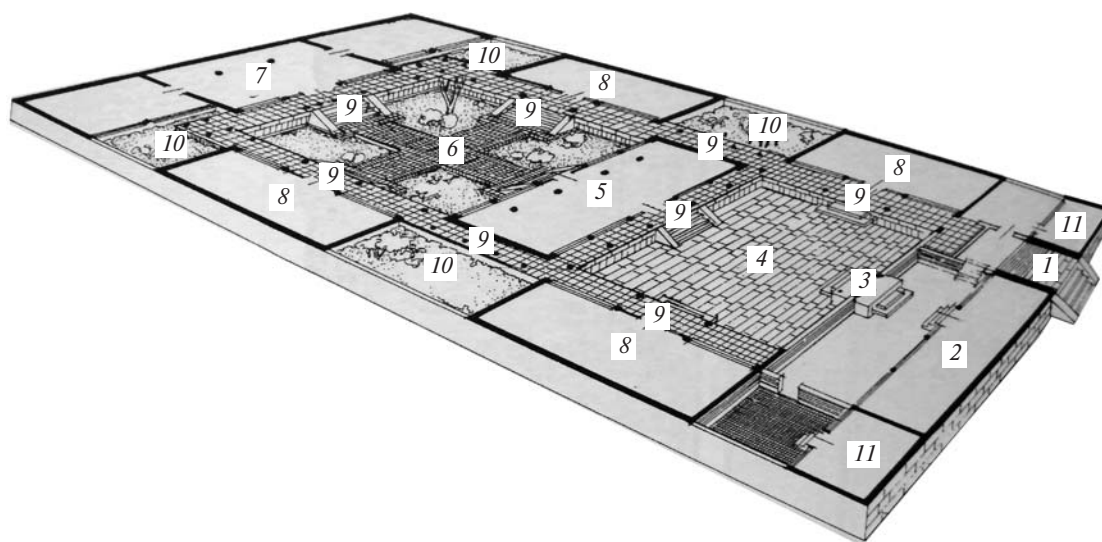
Планировка традиционной усадьбы в Северном Китае: 1 – главный вход; 2 – флигель для работников; 3 – вторые ворота; 4 – передний (внешний) двор; 5 – гостиная и переход к внутреннему двору; 6 – внутренний двор; 7 – главное здание; 8 – флигель; 9 – галерея; 10 – сад; 11 – флигель для гостей
